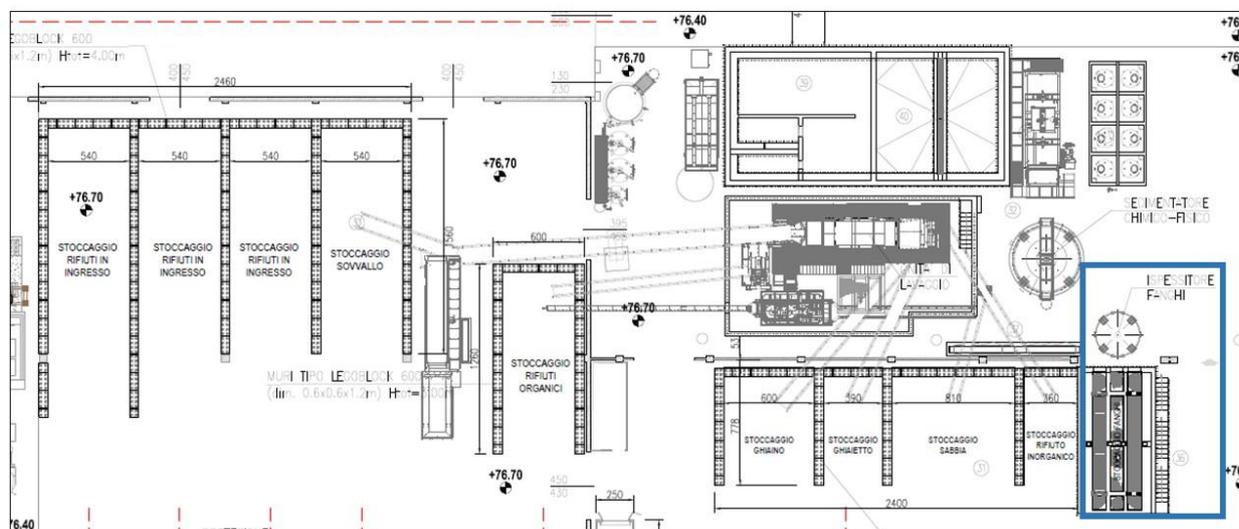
Pianta dell'impianto di soil washing. Con contorno blu viene evidenziata la sezione di accumulo e disidratazione fanghi derivanti esclusivamente dal trattamento delle acque dal soil washing
